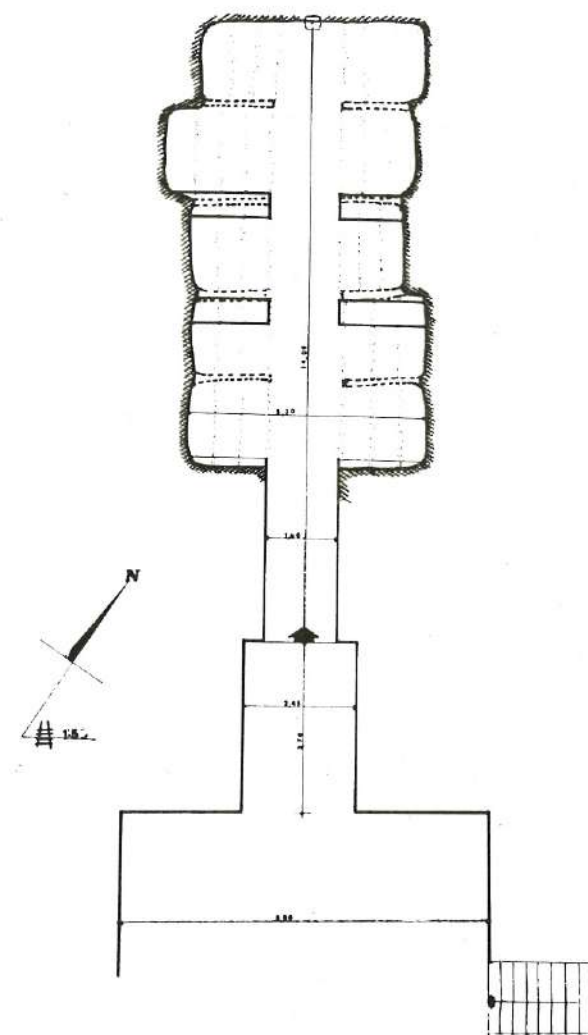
CAPPARELLI: planimetria dell'ipogeo n. 6.
